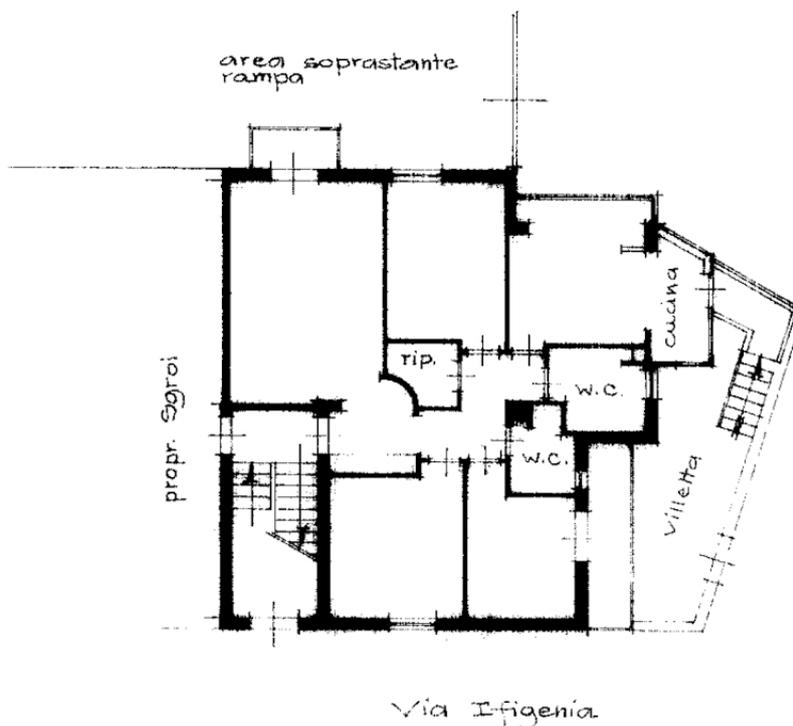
Planimetria catastale attuale (non in scala) dell'immobile pignorato.
